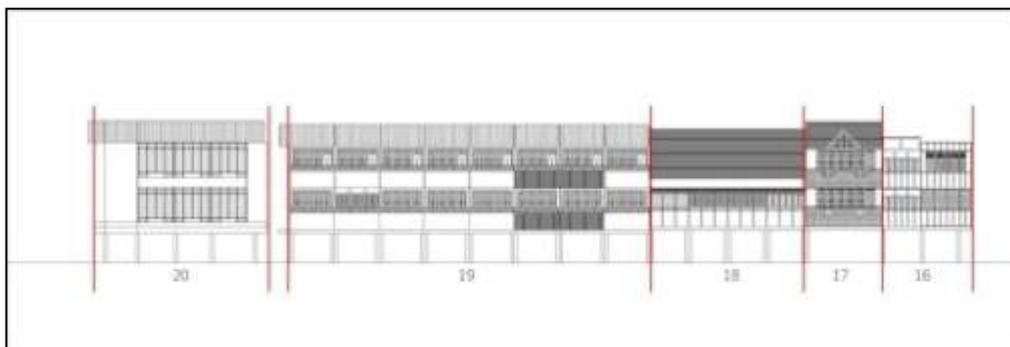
Fasad beberapa bangunan pada batasan penelitian
